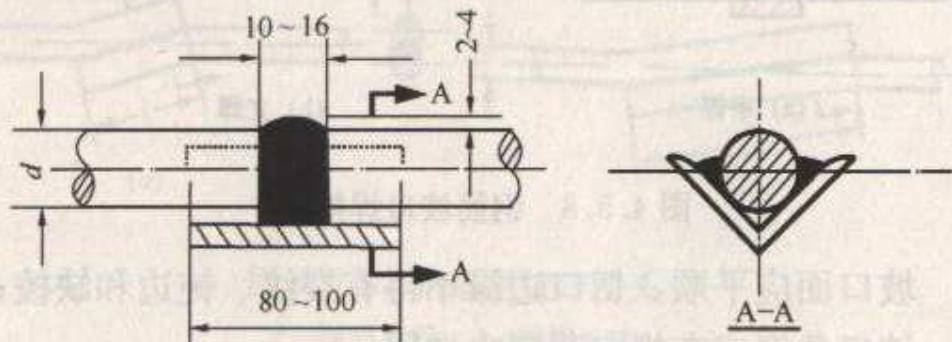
钢筋熔槽帮条焊接头
